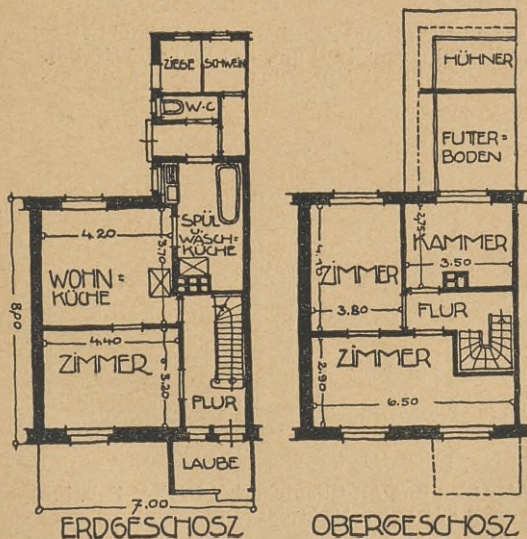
u. 65. Haus der Arbeiter-siedlungen von Friedr. Krupp in Essen. Beb. Fläche 56 qm, des Stallanbaues 17,40 qm. Architekt Schmohl
